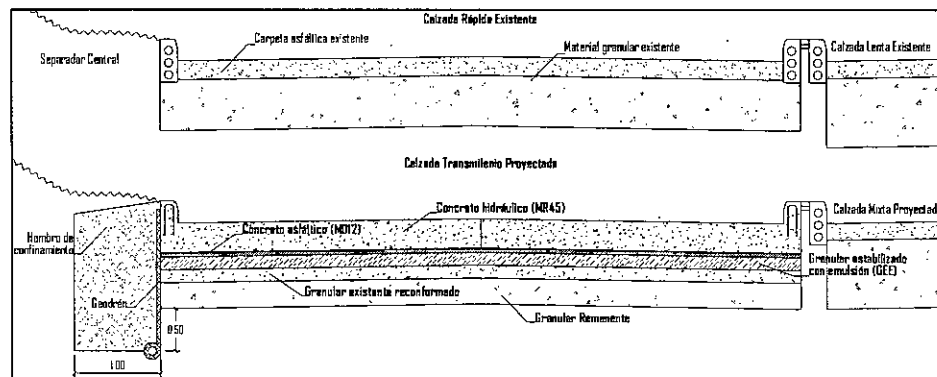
Reconstrucción de calzadas mixtas como Carriles Exclusivos o Mixtos
